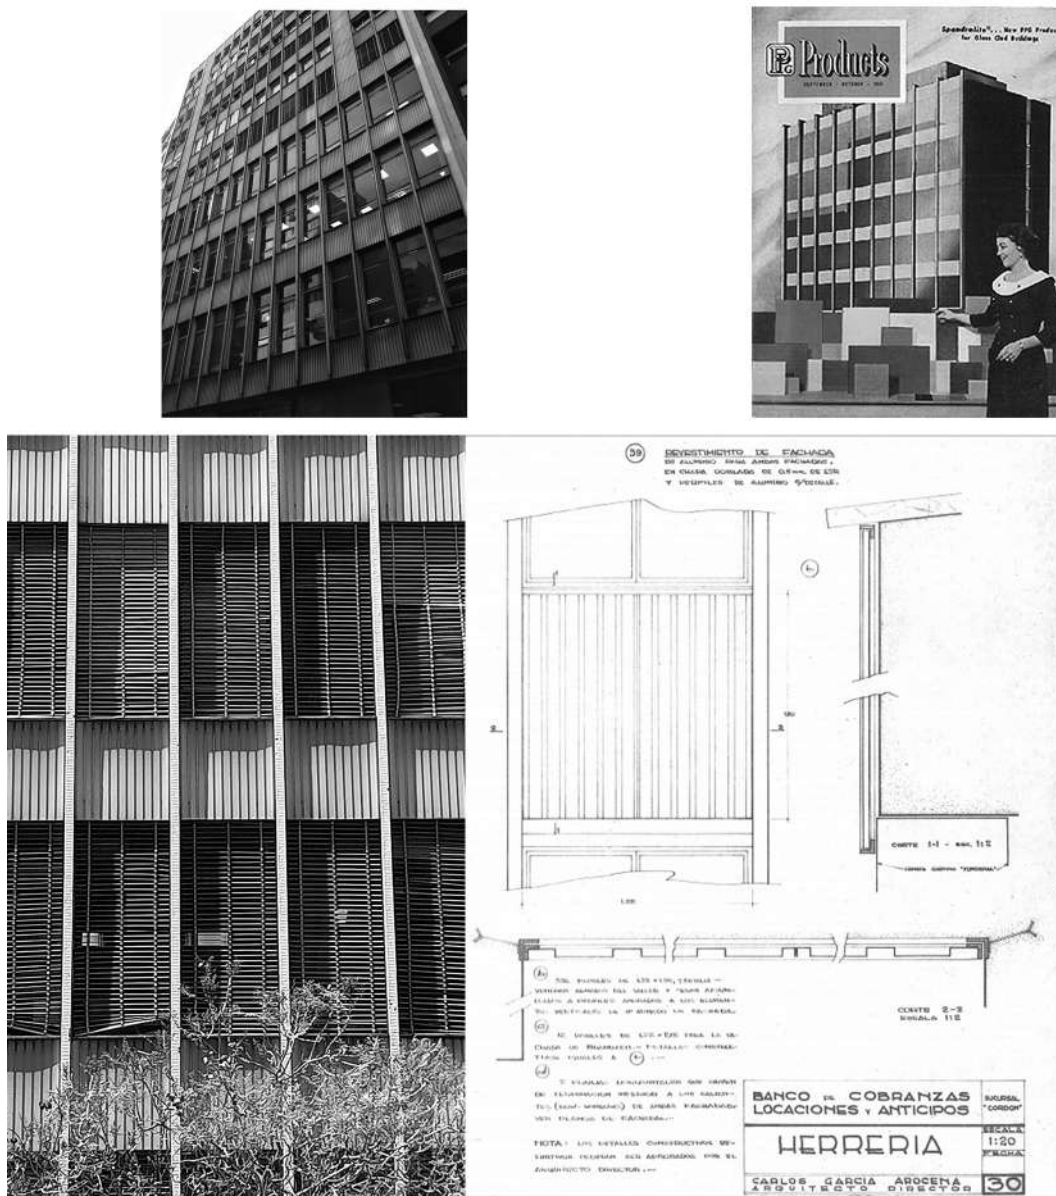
La solución de los *spandrells* del BCLA. Vistas de las fachadas sobre la Av. 18 de Julio y Brandzen, junto al detalle contenido en la lámina 30 del proyecto ejecutivo, e imagen del catálogo de la Pittsburg Plate Glass Company, 1955. Recuperado de <https://dahp.wa.gov/historic-preservation/historic-buildings/architectural-style-guide/curtain-wall>
